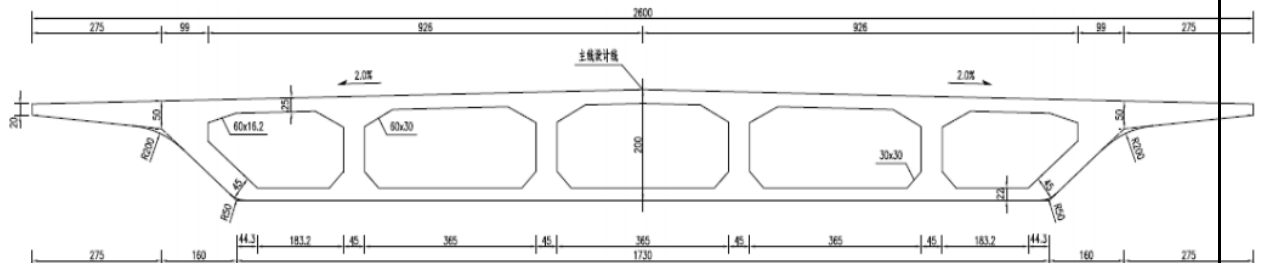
主线高架桥 B=26m 现浇箱梁横断面图
